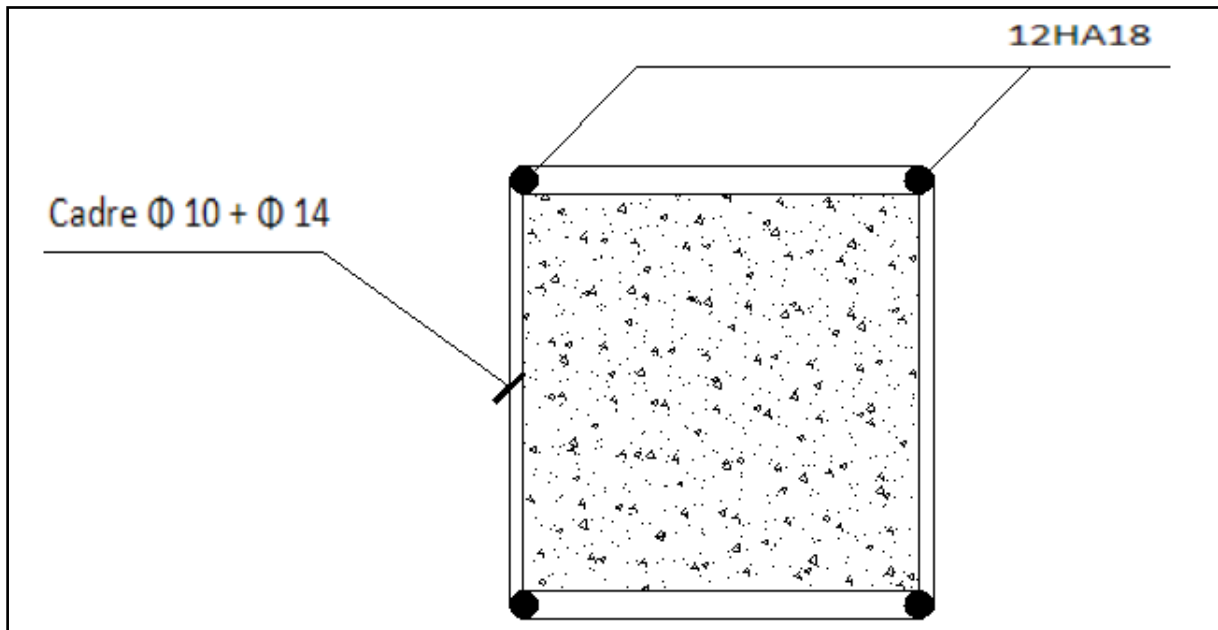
Schéma de ferrailage au droit de l'ancrage
